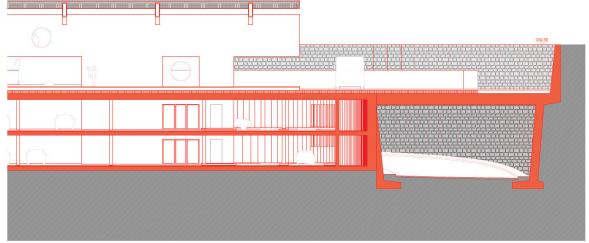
Prolungo copertura Tunnel di Besso - Sezione
